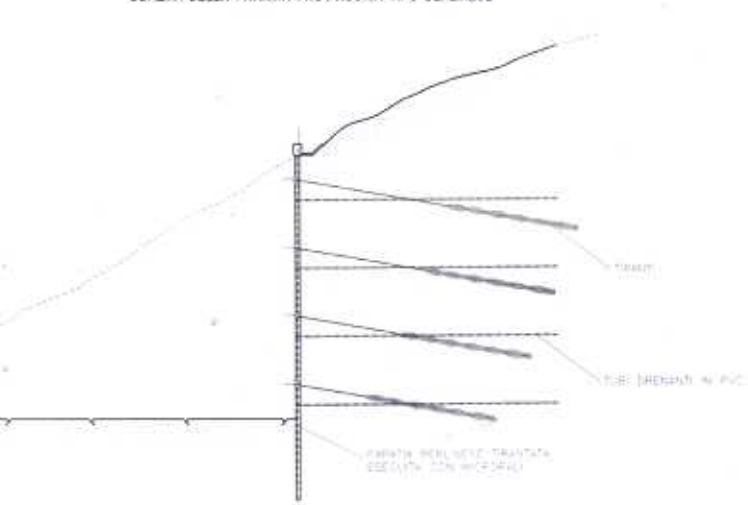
Schema della berlinese provvisoria operata presso la pila 4
